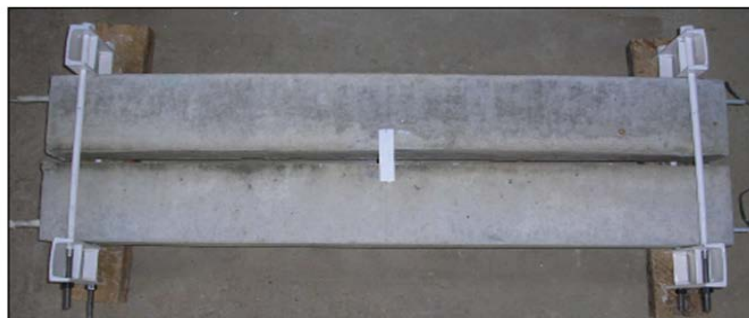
Sistema de pré-carga aplicado nas vigas de concreto
